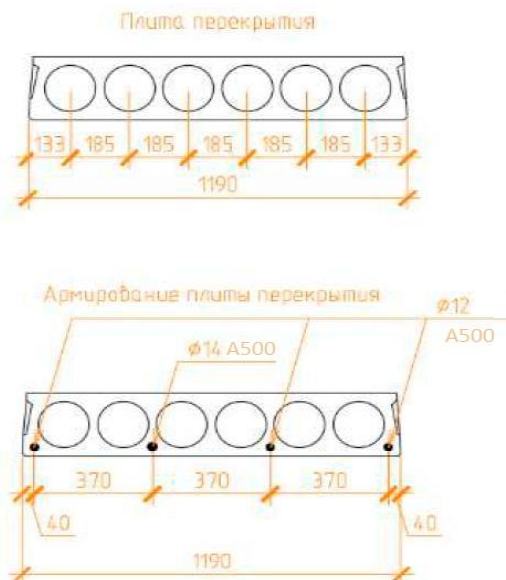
Расчетная схема плиты перекрытия (разработано авторами)
